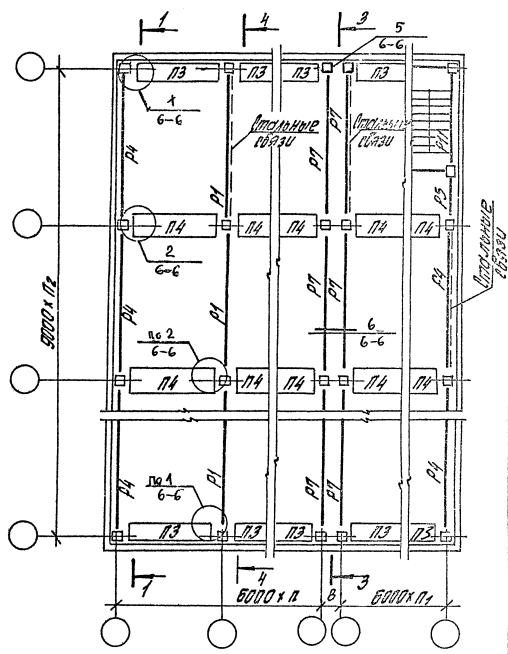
Схема расположения ригелей и связей плит в перекрытиях зданий с сеткой колонн 9х6 м
